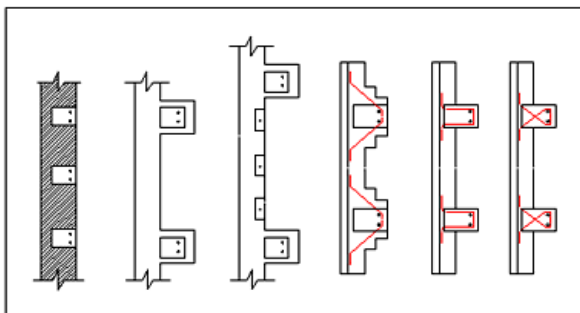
Muri armati denominati “pocket type walls” (3)
